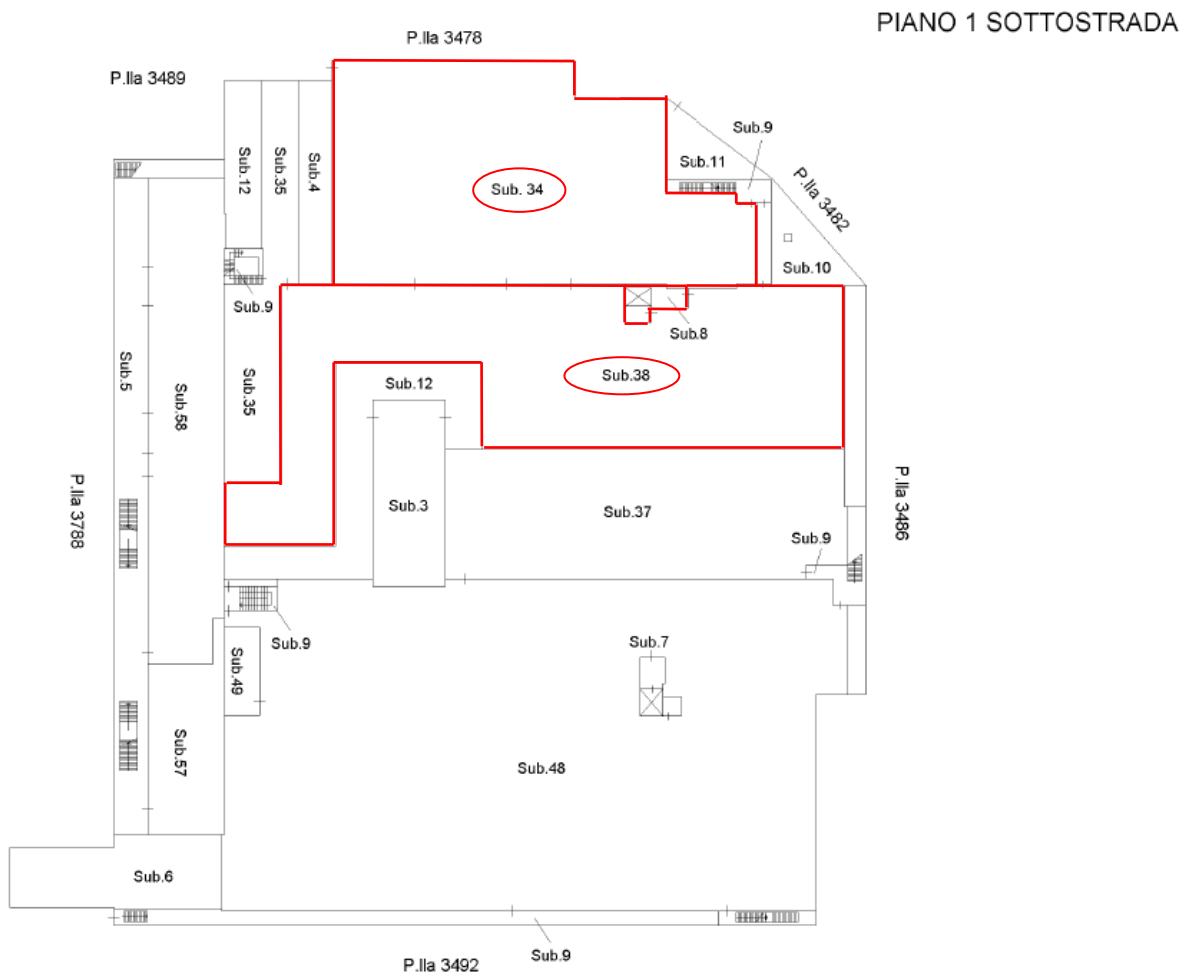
Individuazione dei subalterni (34 e 38) nell'elaborato planimetrico (piano S1)
